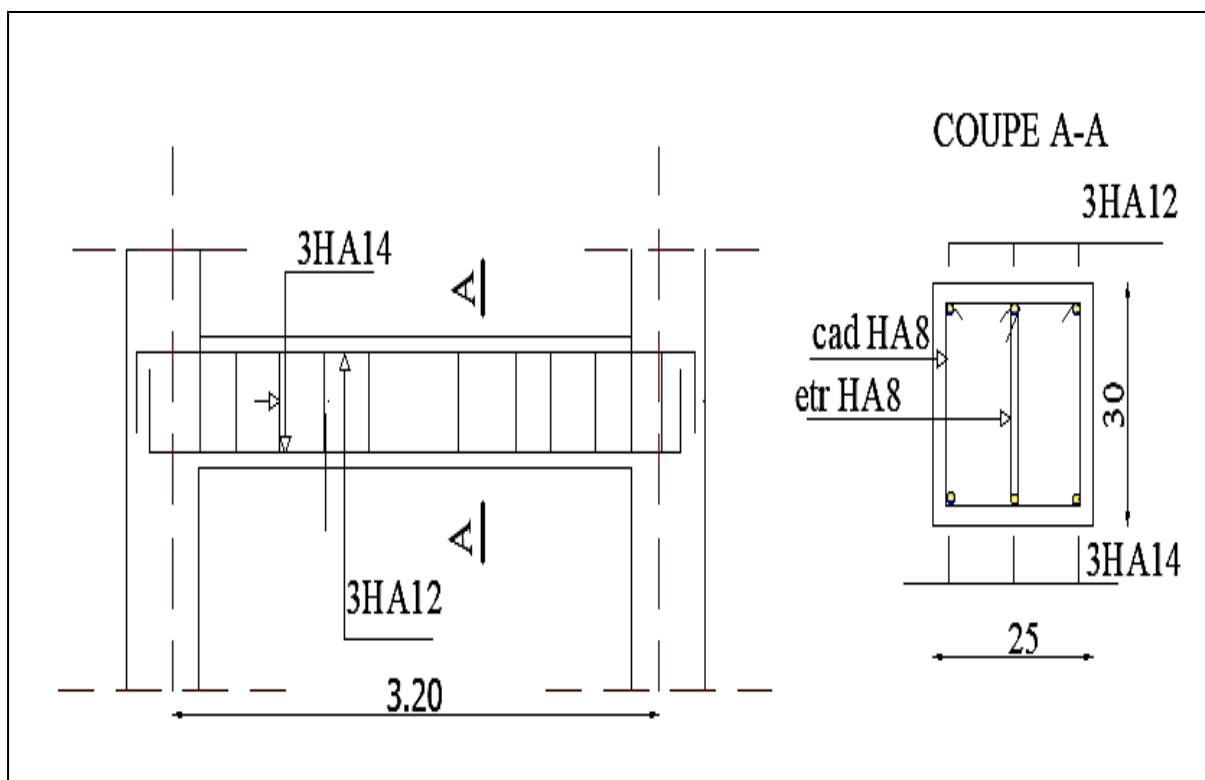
Schéma de ferrailage de la poutre palière.
